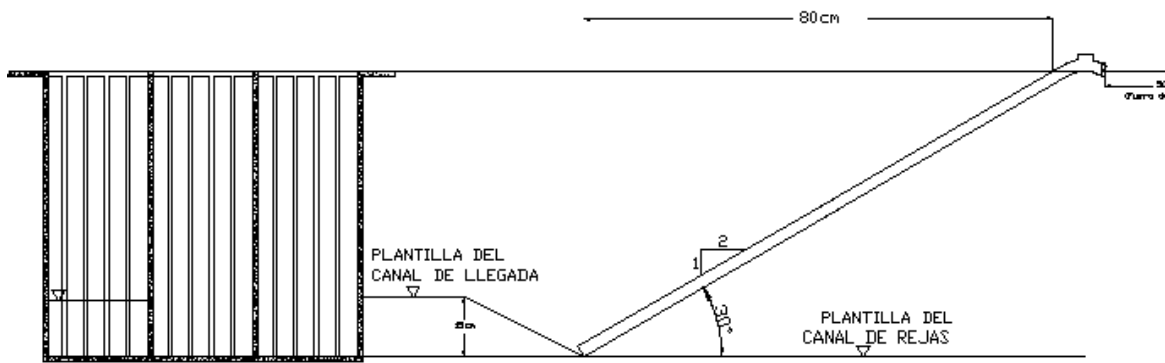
Canal de rejas y canal de transición. Vista lateral
